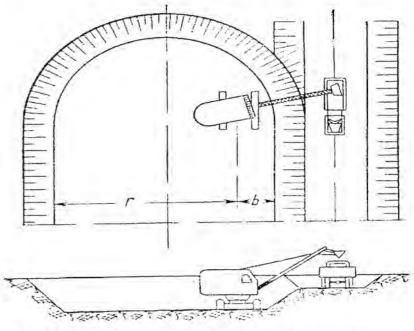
Схема разработки выемки продольными проходками экскаватора. оборудованного прямой лопатой.
